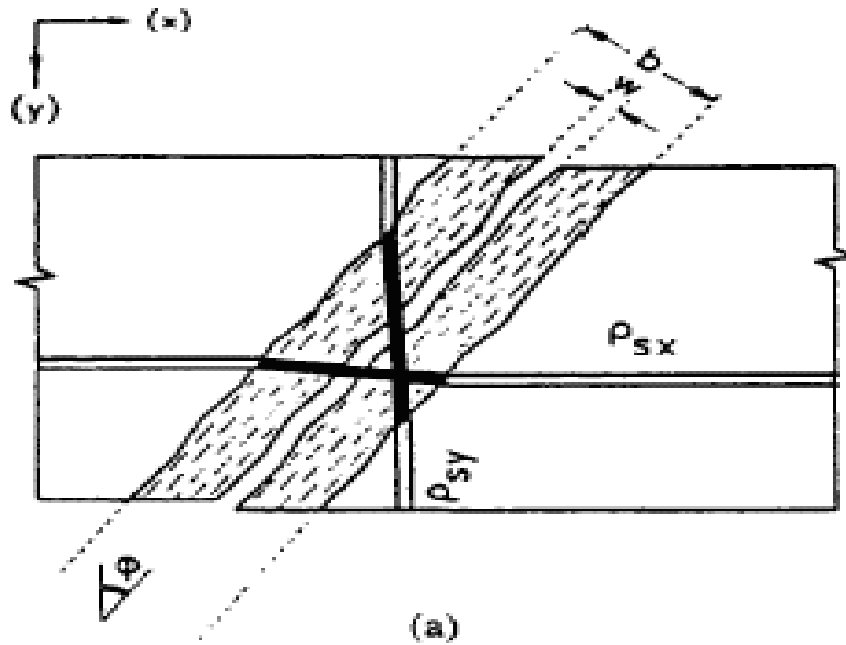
Flexion locale des barres d'armature au droit d'une fissure
